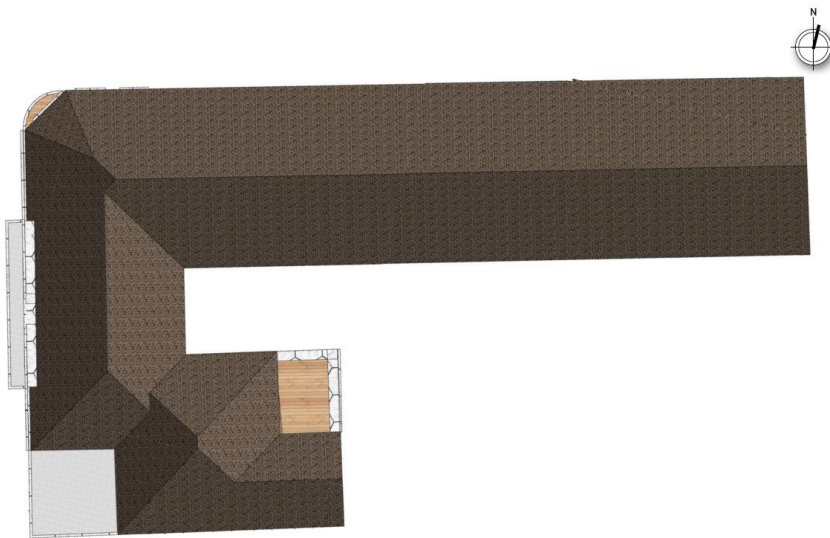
Biblioteca de la ciudad – Planta de Cubierta
